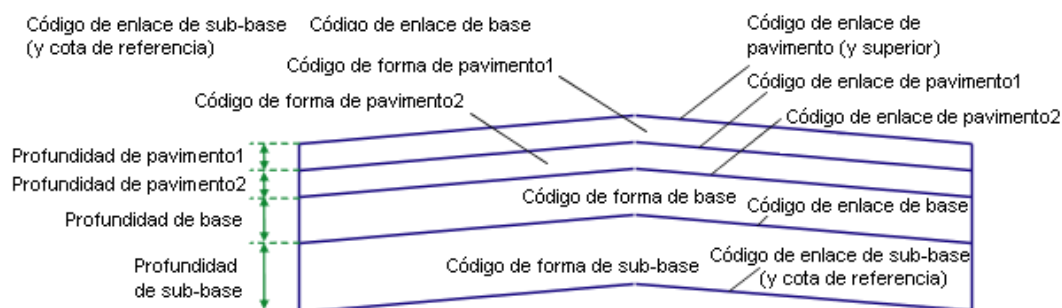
Estructura típica subensamblaje de secciones pavimentadas. (Fuente: Autodesk)
